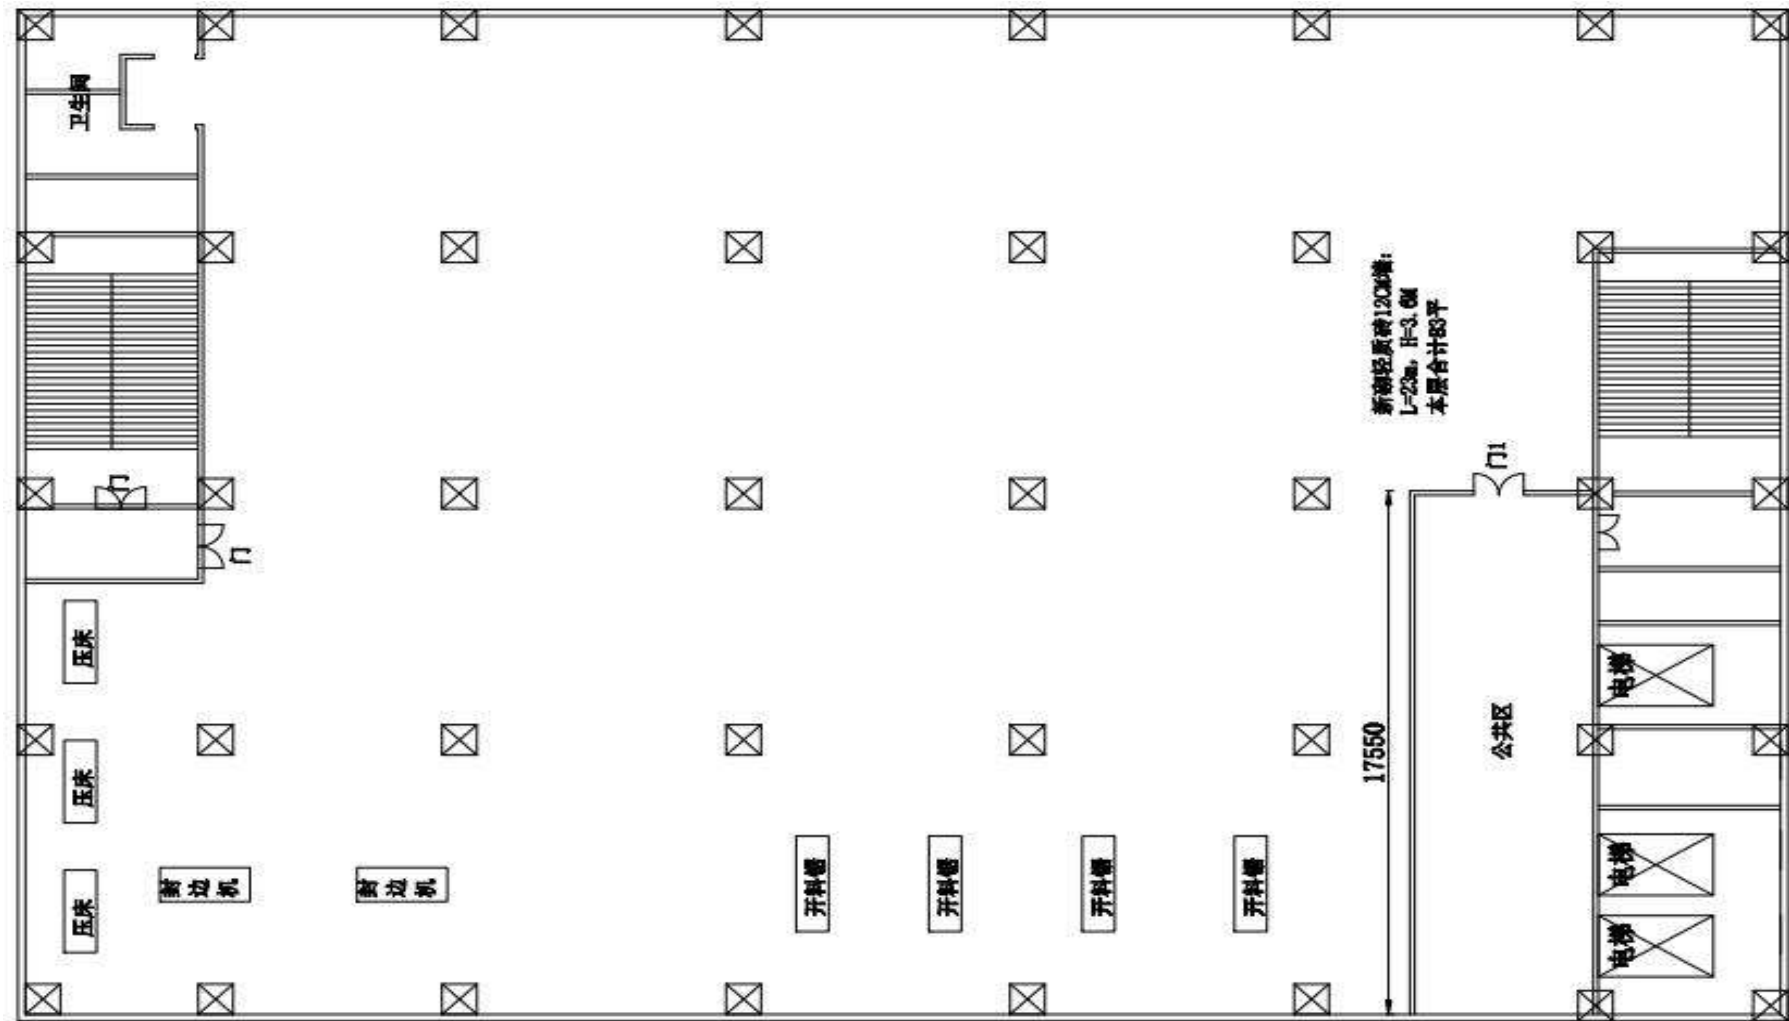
项目 3A 号厂房 8 楼总平面布置图
